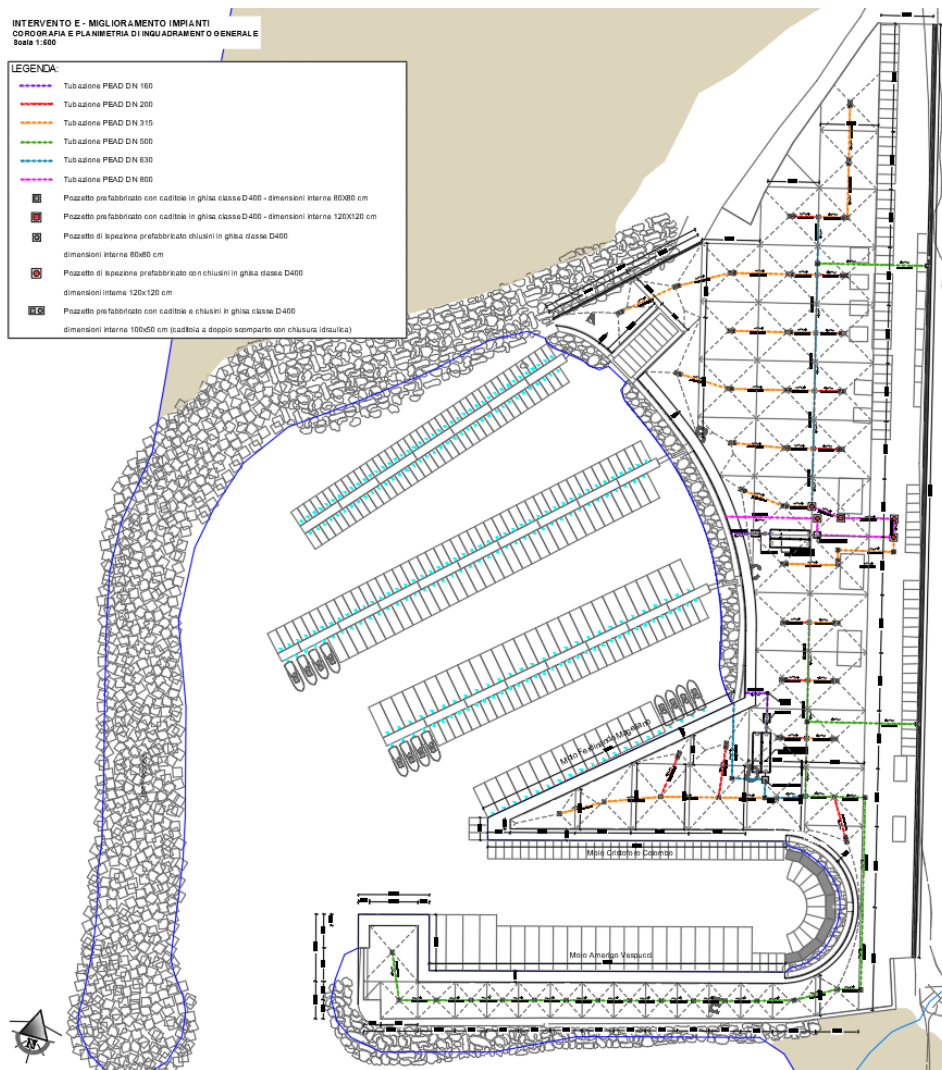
Intervento E - Planimetria con indicazione impianto acque meteoriche
